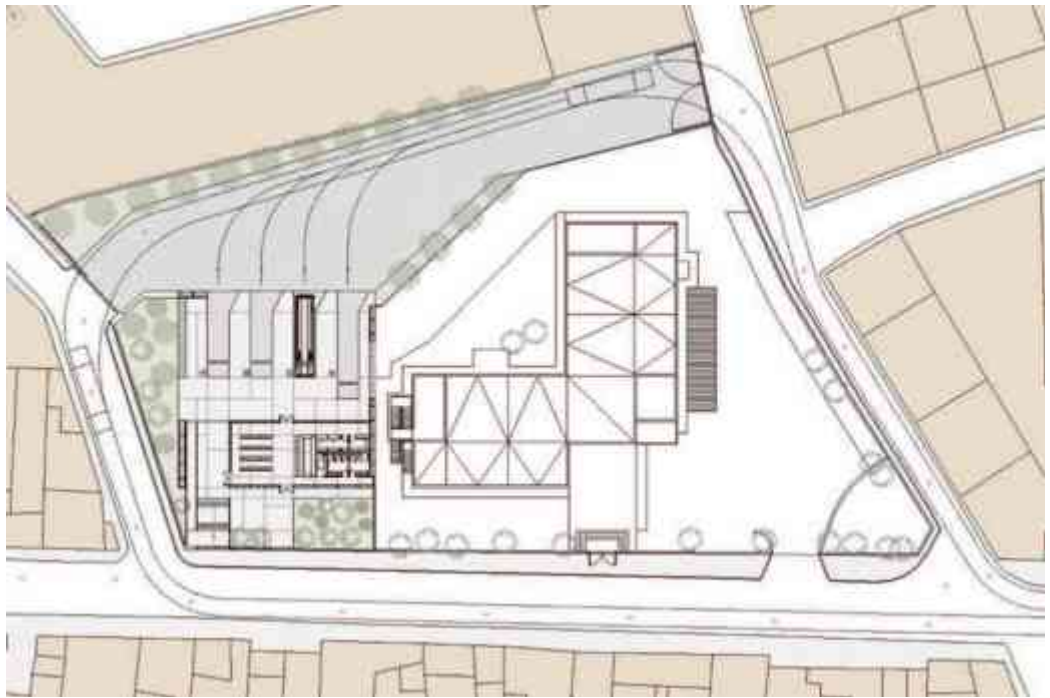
Planta arquitectónica de la central de Porcuna, España. Archdaily.
